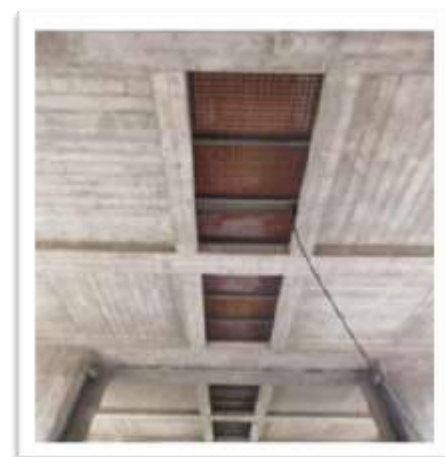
Passarelas de Inspeção do pavimento técnico. Fonte Arquivo pessoal.
